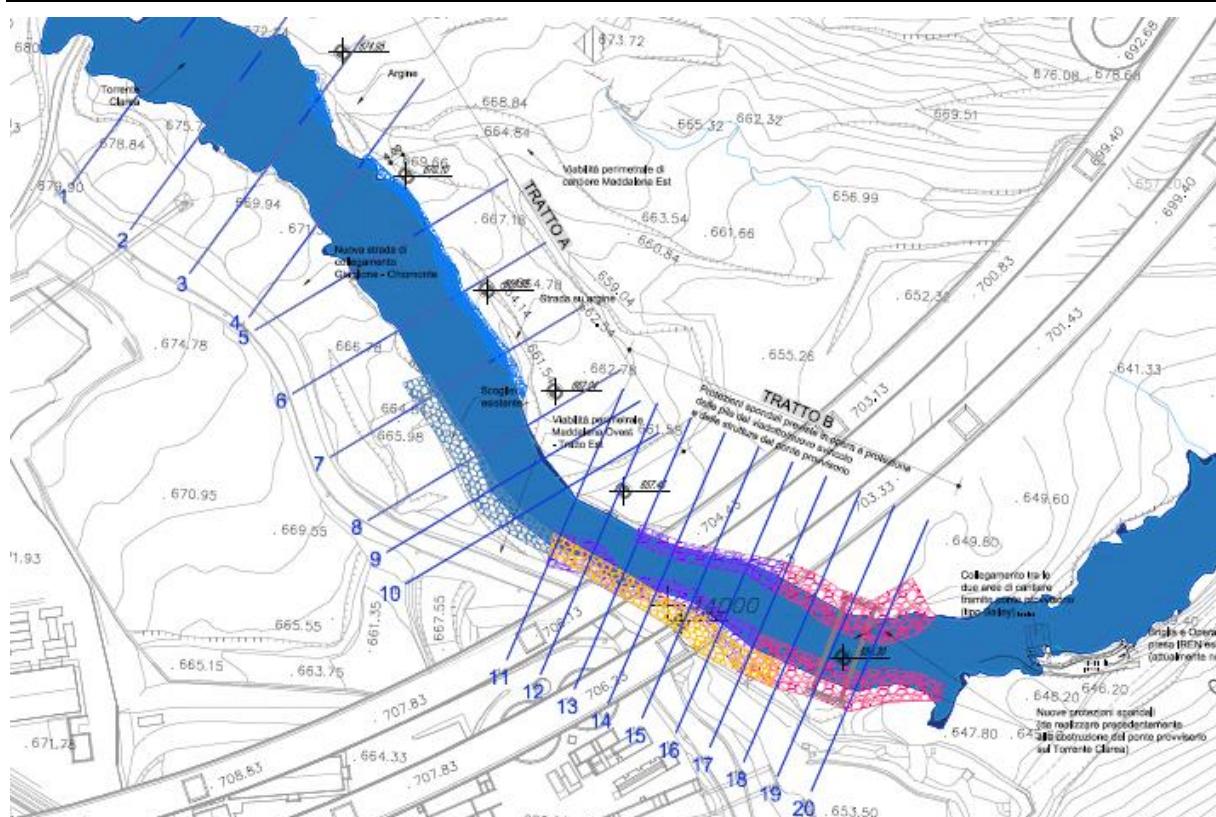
Planimetria di individuazione delle sezioni d’alveo
